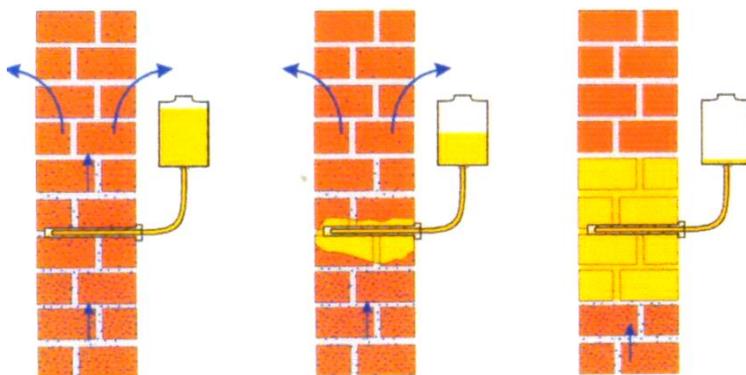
Инъекционная пропитка кирпичных стен для создания горизонтальной гидроизоляции
